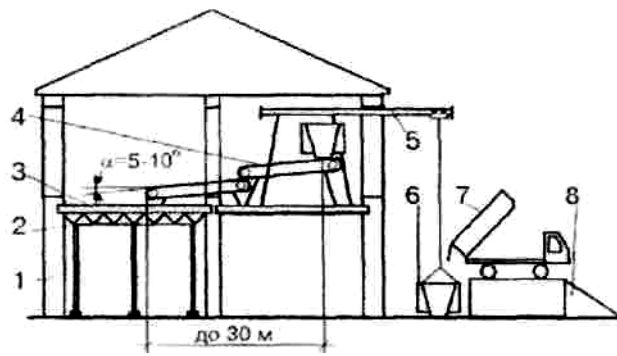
Схема виробництва робіт по бетонуванню перекриттів будівлі, що реконструюється:
